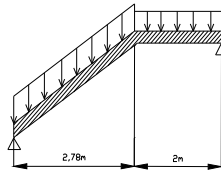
Coupe longitudinale de l'escalier à étudier
